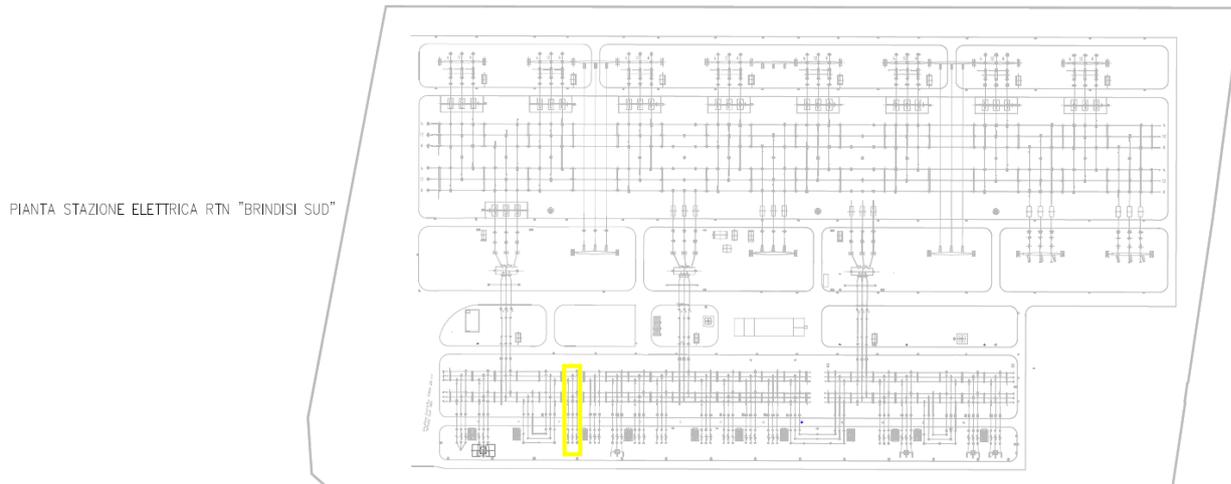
Pianta Stazione Elettrica RTN "Brindisi Sud"
